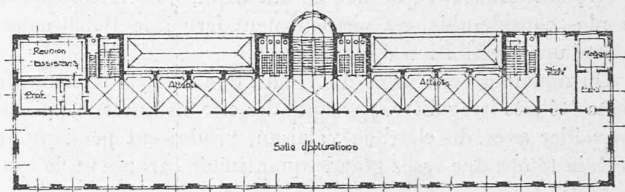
Plan du 1^{er} étage. — 1 : 800.
